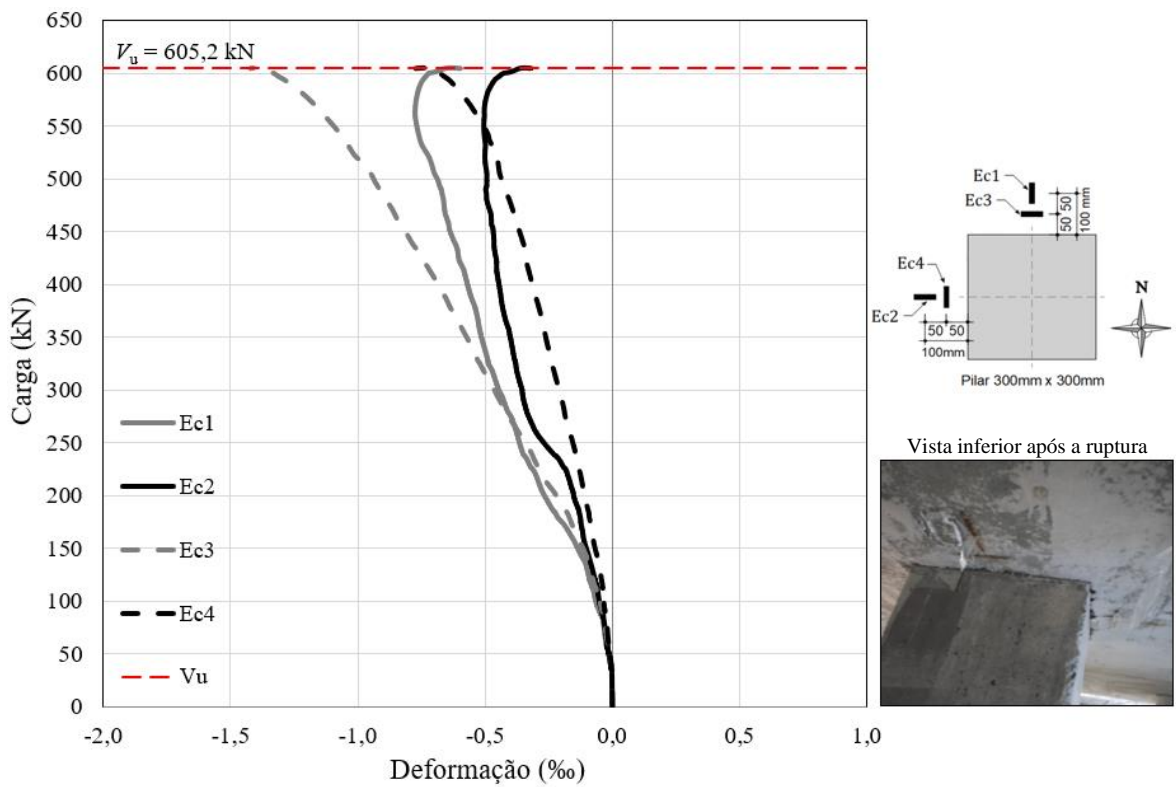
Deformações na superfície inferior do concreto da laje CA-05
